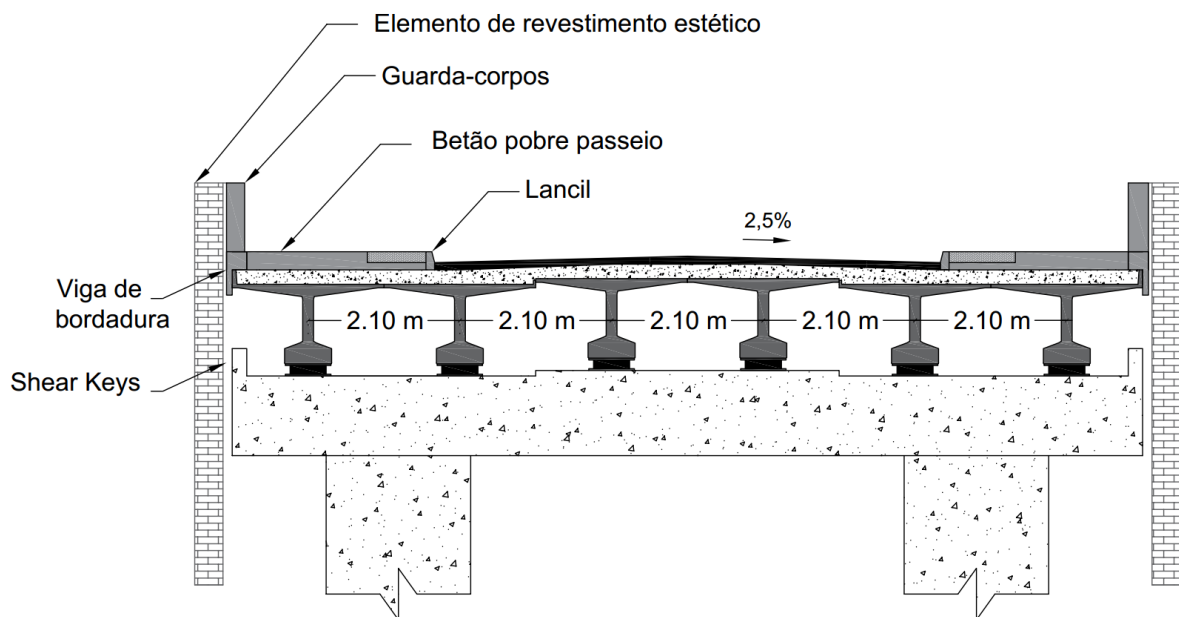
Alçado frontal tipo do alinhamento de pilares, onde estão incluídas duas fachadas de alvenaria figurativas dos elementos de revestimento.
